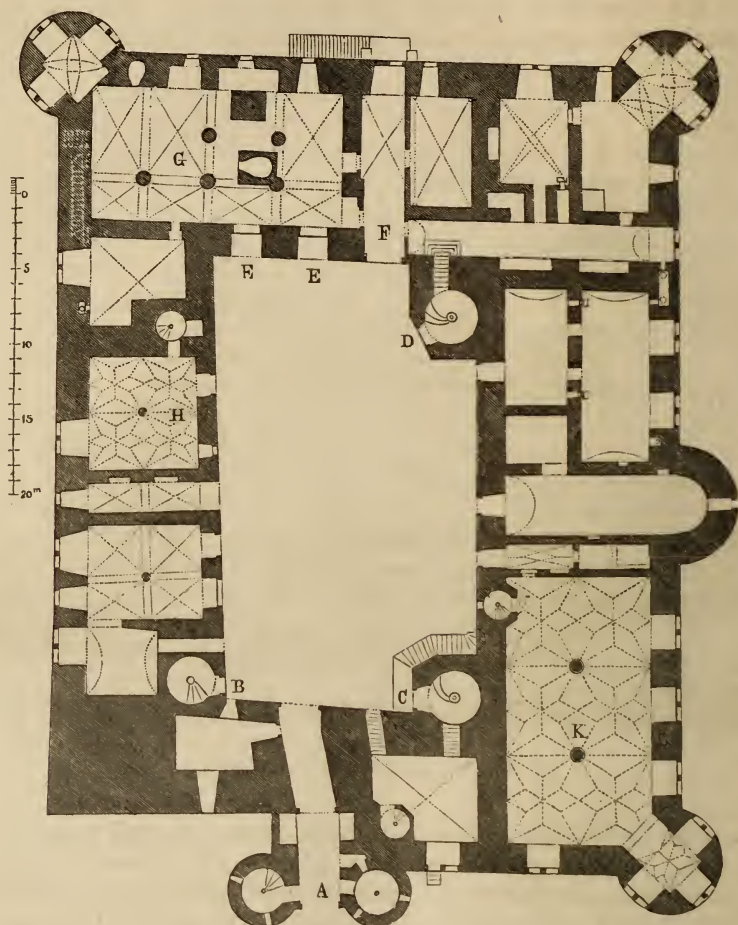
Schloss zu Neuenstein. Grundriss des Erdgeschosses.
